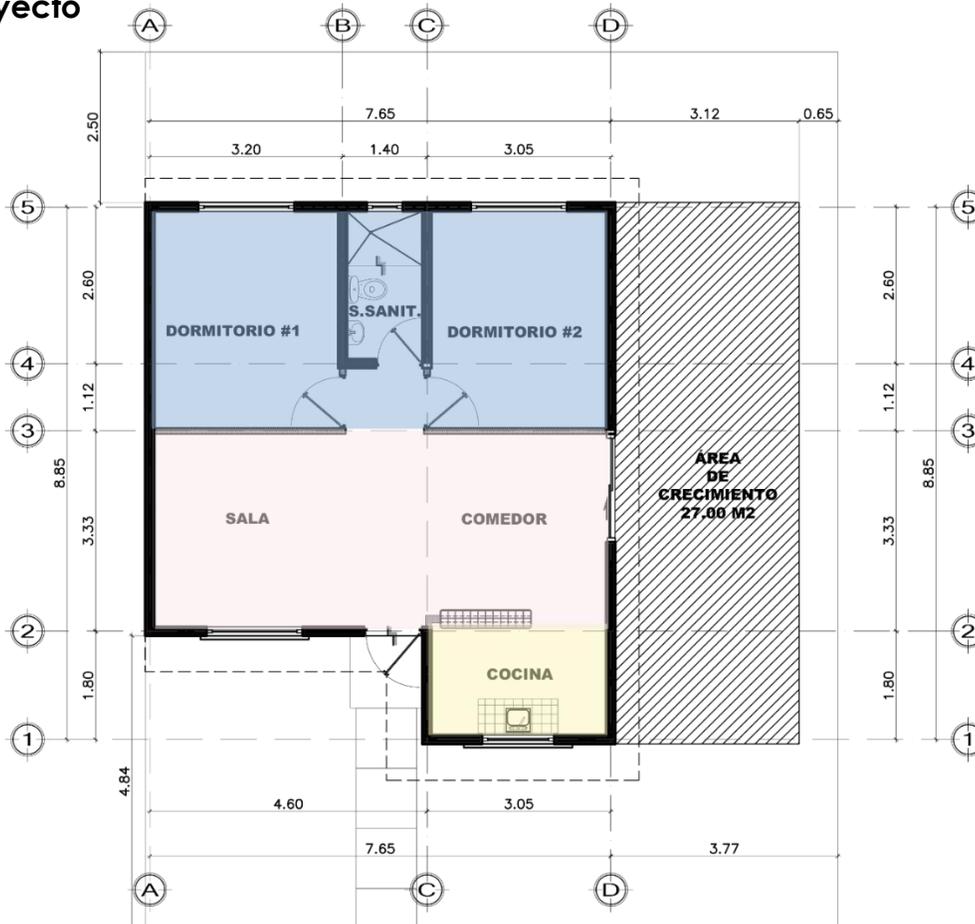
Planta arquitectónica zonificación y área de crecimiento modelo Guanacastillo
